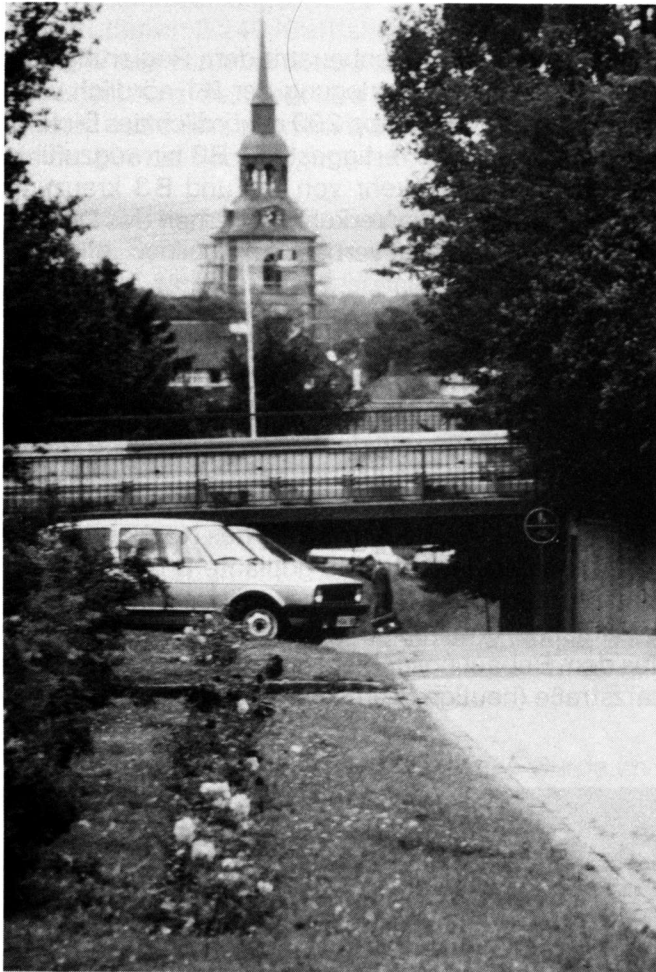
B 1 über Radwegtunnel – Sonnenbergstraße
